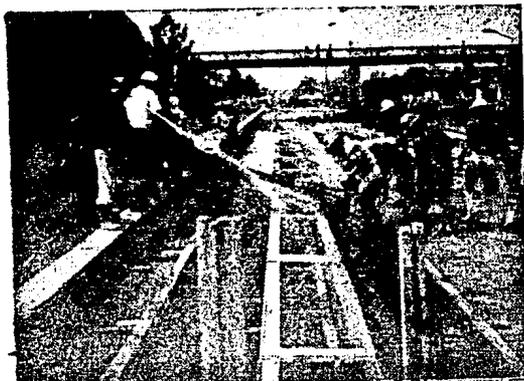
CIMBRA Y COLADO DE BROCAL
